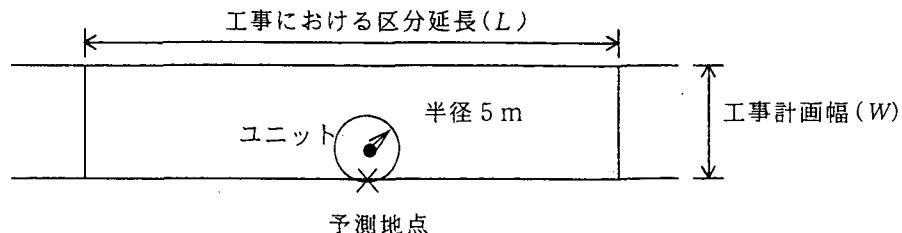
施工範囲が特定できない場合の施工範囲とユニットの配置例
